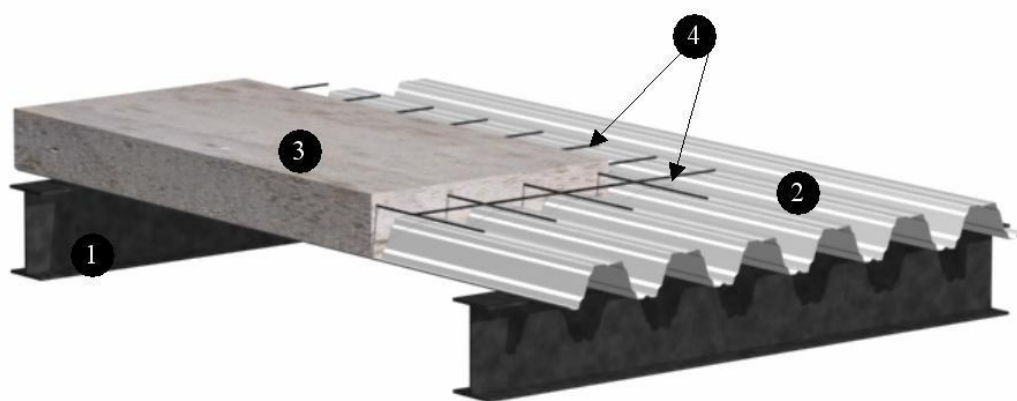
Схема конструкции перекрытия с плитой из конструкционного бетона по профлисту.
